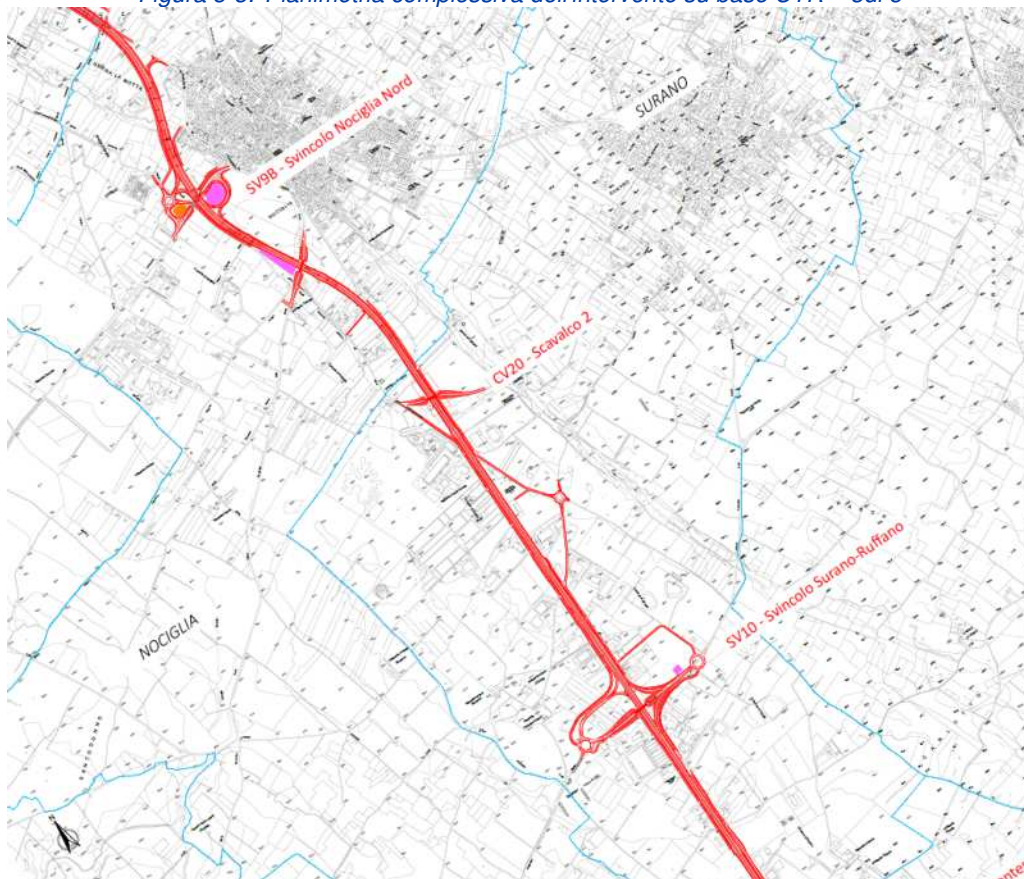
Planimetria complessiva dell'intervento su base CTR – 4 di 5
